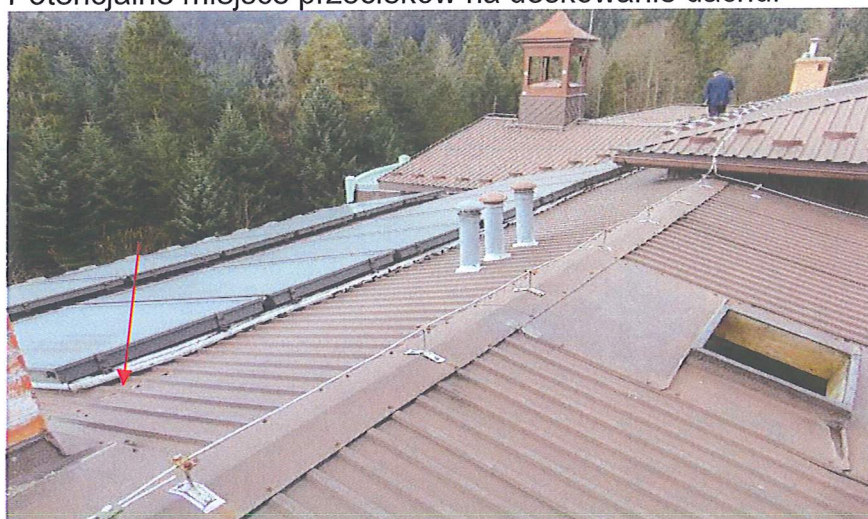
Fotografia dachu wykonana w 03.2019 r. Widok połaci w kierunku południowym. Styki poprzeczne blach. Potencjalne miejsce przecieków na deskowanie dachu.
